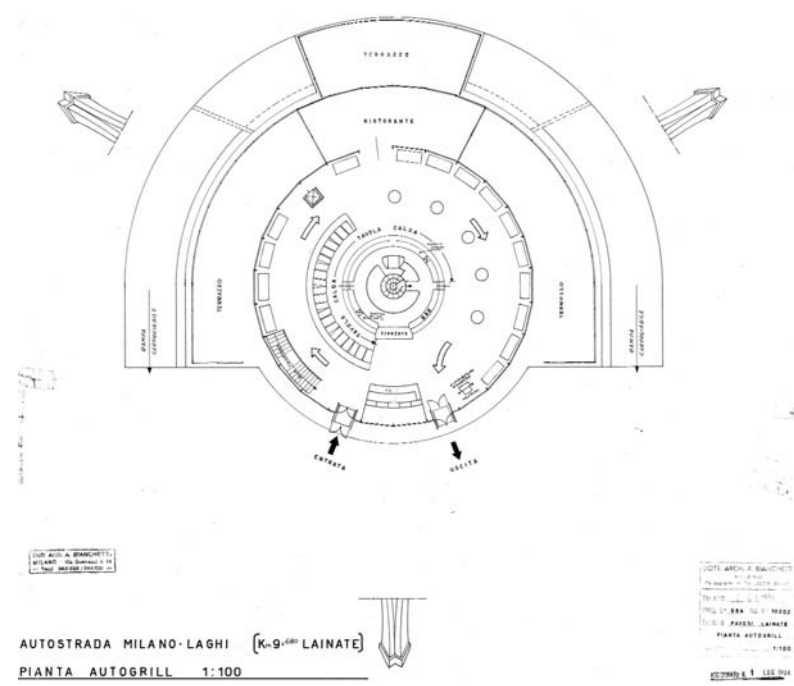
(AAB) La pianta del piano grill dopo l'ampliamento del 1961
